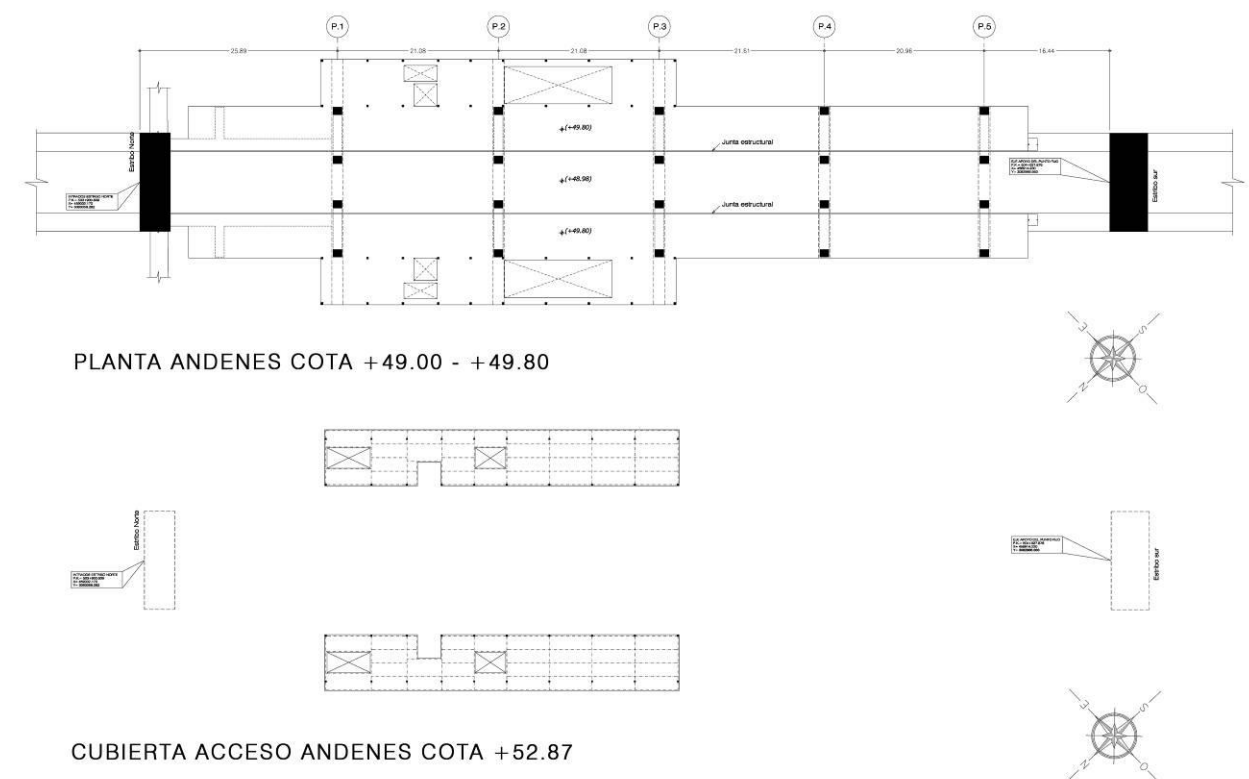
Planos de estructuras de la estación (fuente: PC estación P.I. Arinaga)
